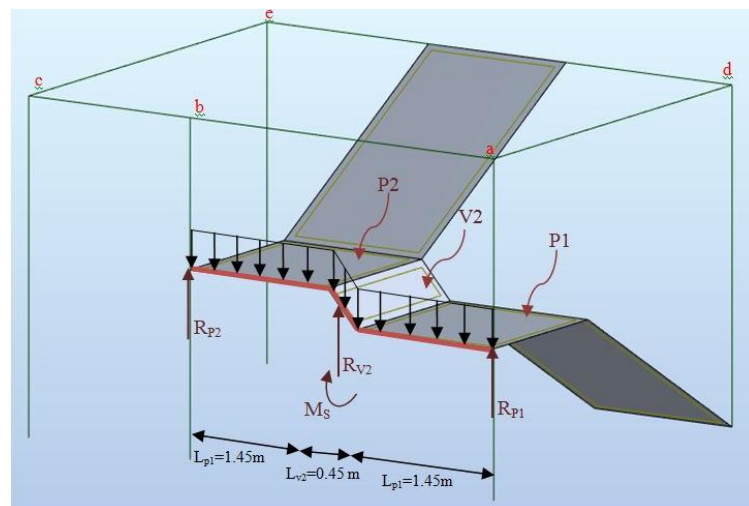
Représentation du chargement revenant à la poutre brisée.
